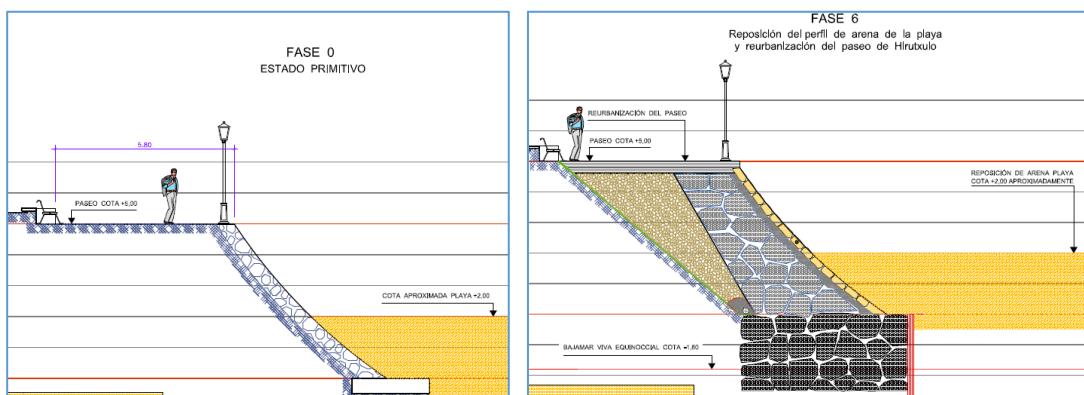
En el plano nº3 del Proyecto de Reconstrucción.
